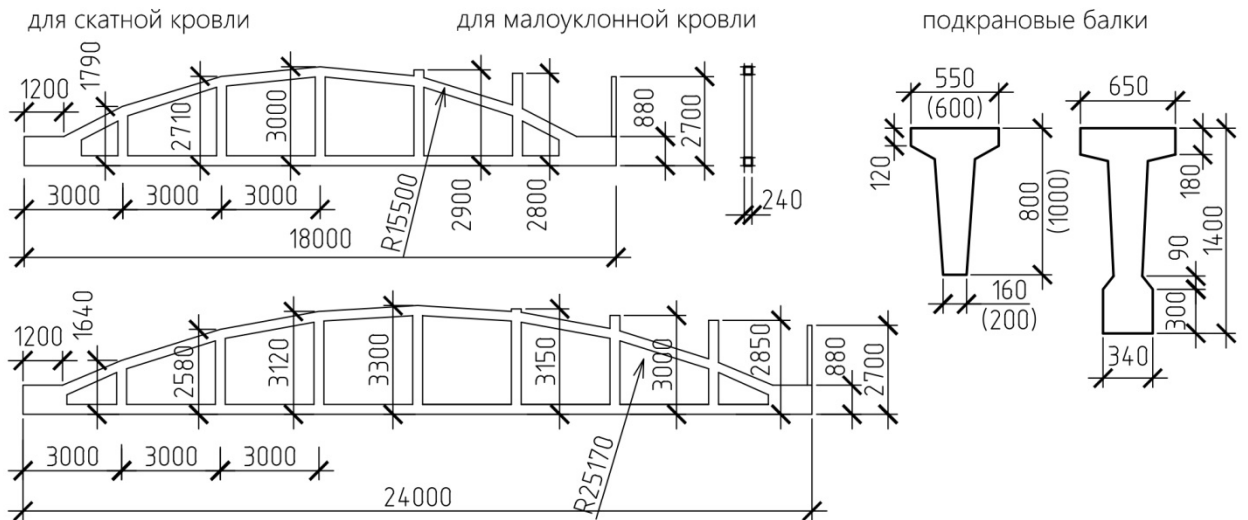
Железобетонные стропильные безраскосные арочные фермы и подкрановые балки
